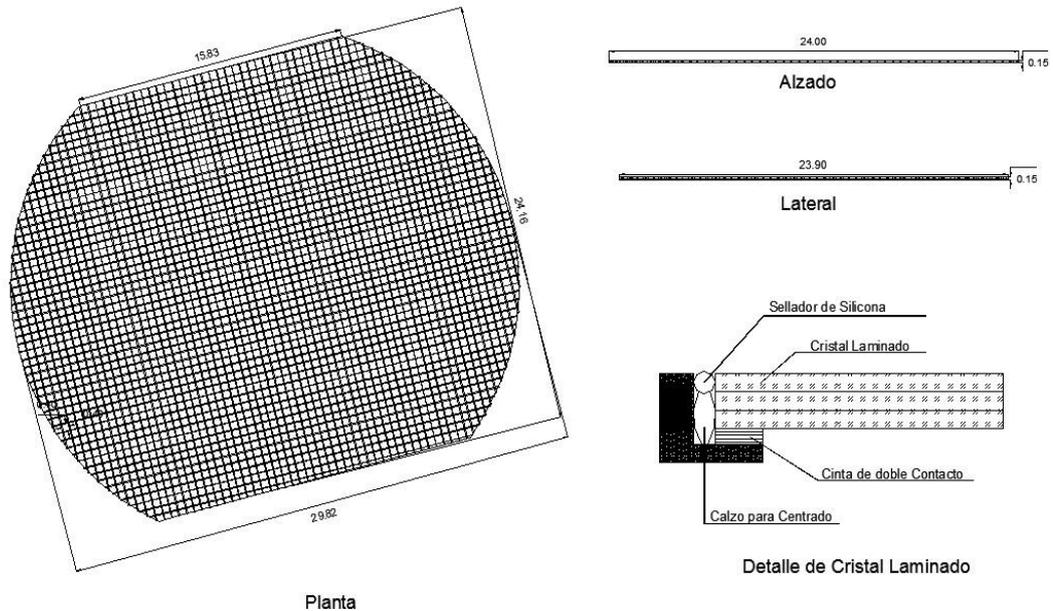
Detalle técnico Piso de Cristal Laminado
